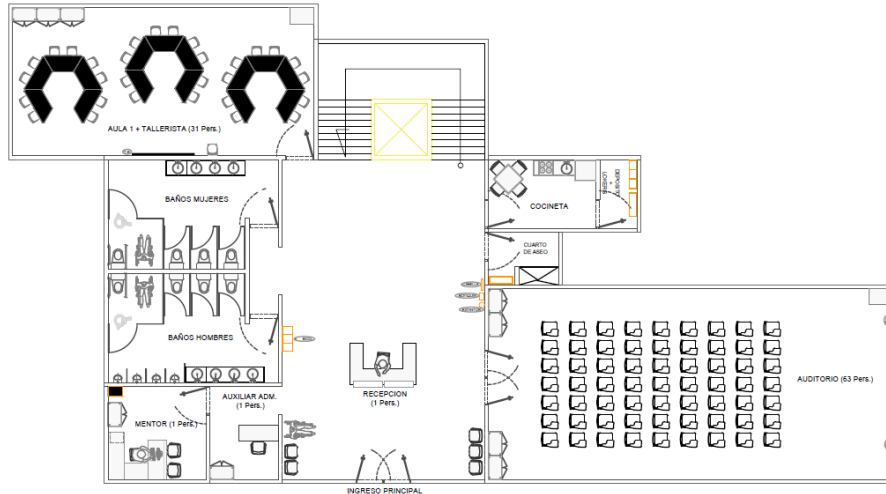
Propuesta Arquitectónica Sacúdete Tipo III – Piso 1
